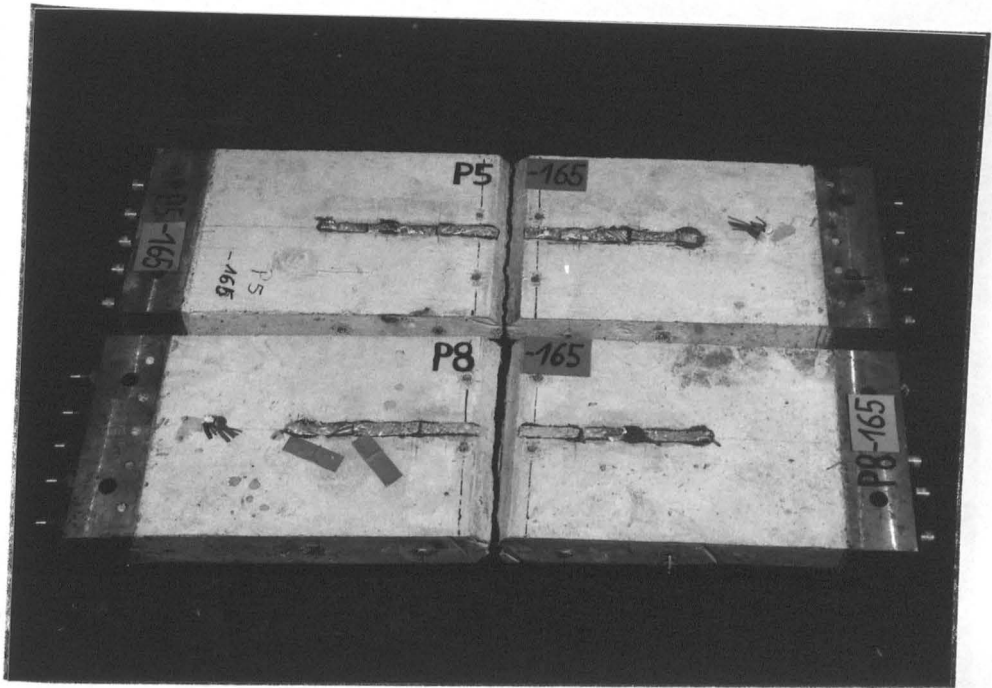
Spannbetonscheiben nach dem Zugversuch
